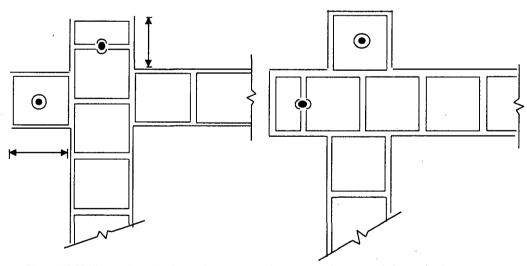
Vigas soleras (v.s.) son elementos que dan amarre a los muros de los cuales toman cargas o se encuentran formando parte integrante.
